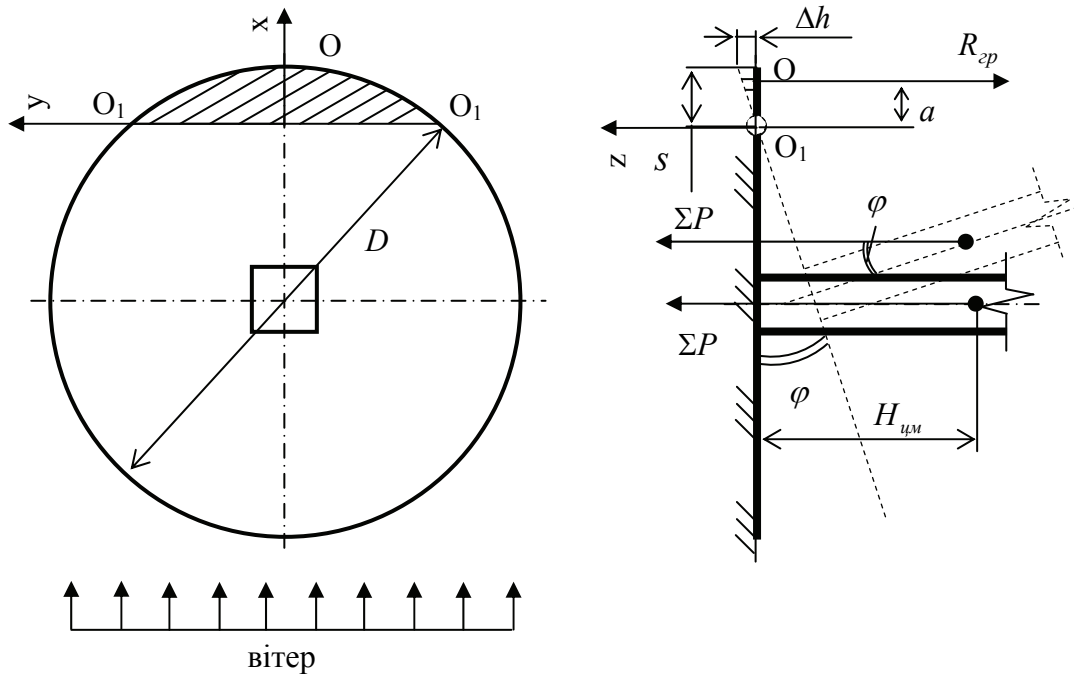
Розрахункова схема опорної платформи безфундаментної баштової споруди на пружному ґрунті
